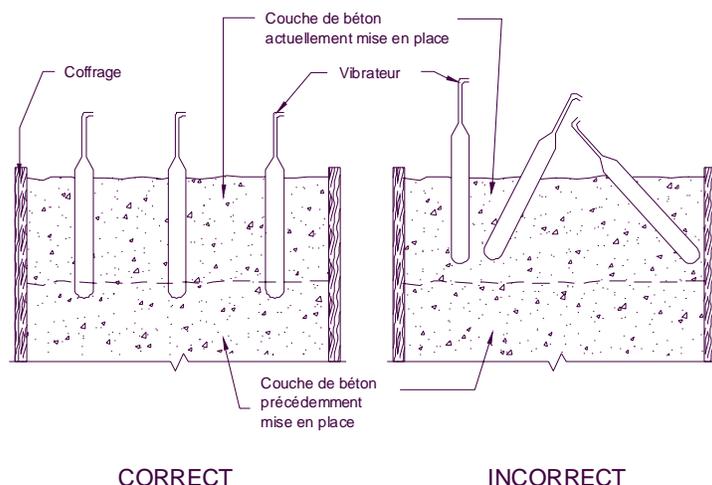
Positions du vibreur dans un coffrage vertical
